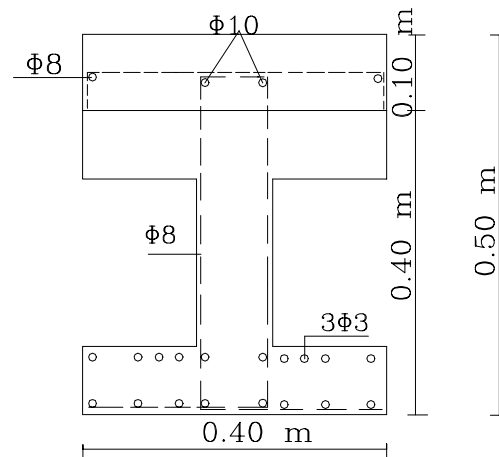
SECCION TRANSVERSAL DE LA VIGA
